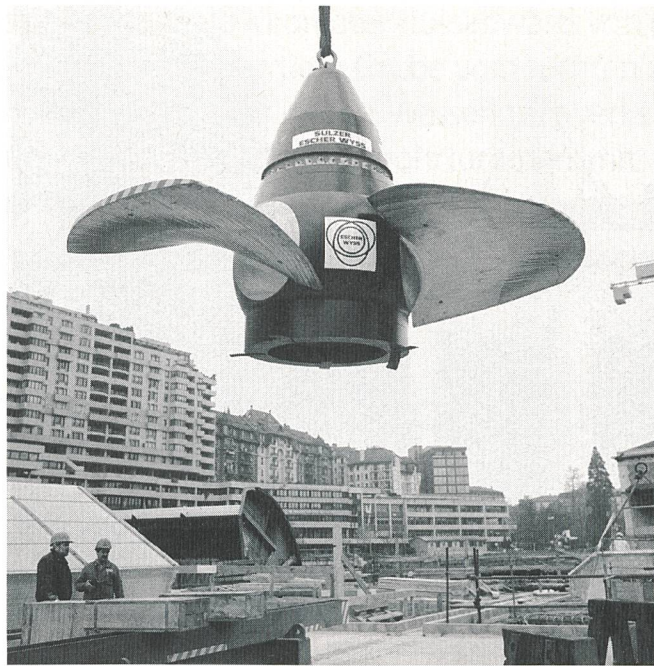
La première des trois roues Kaplan est arrivée en février 1993 sur le chantier de construction situé au centre de la ville de Genève
